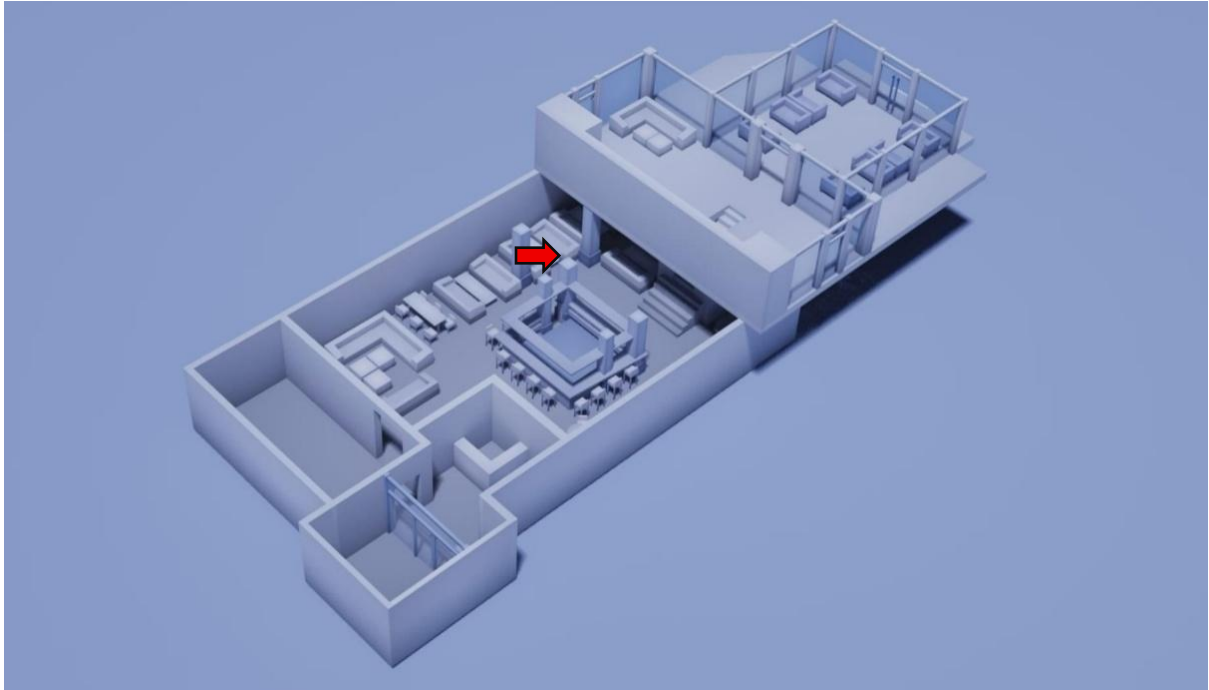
Pianta generale, Radio Télévision Suisse, rts.ch, Le plan du bar "Le Constellation" à Crans-Montana
